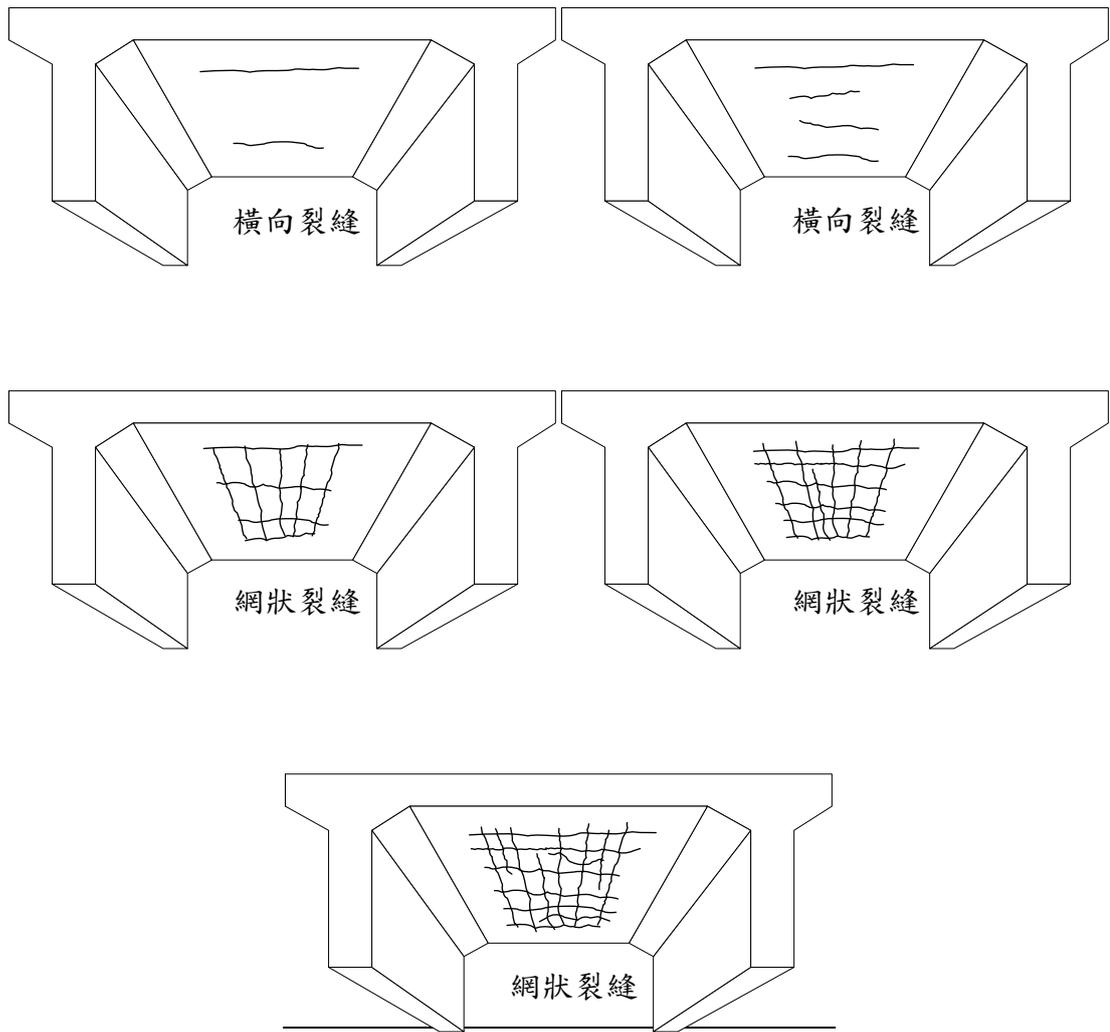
混凝土橋面板裂縫示意圖
